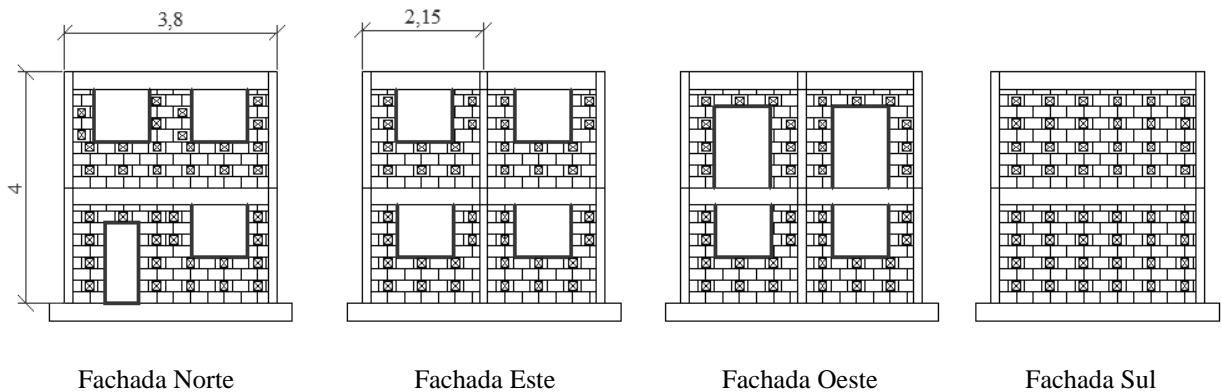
Fachadas e dimensões (em metros) dos modelos ensaiados.
